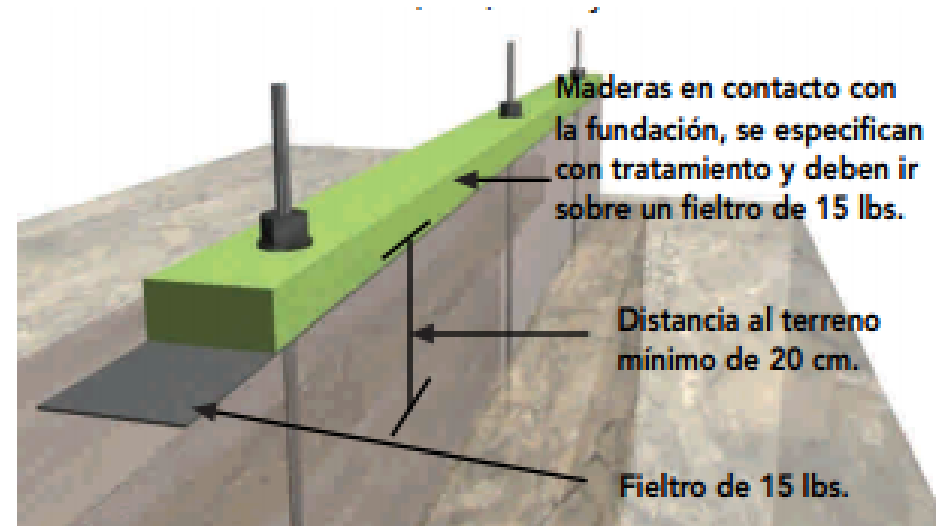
20: Fundación continua de hormigón de altura mínima de 20 cm en punto más desfavorable.
